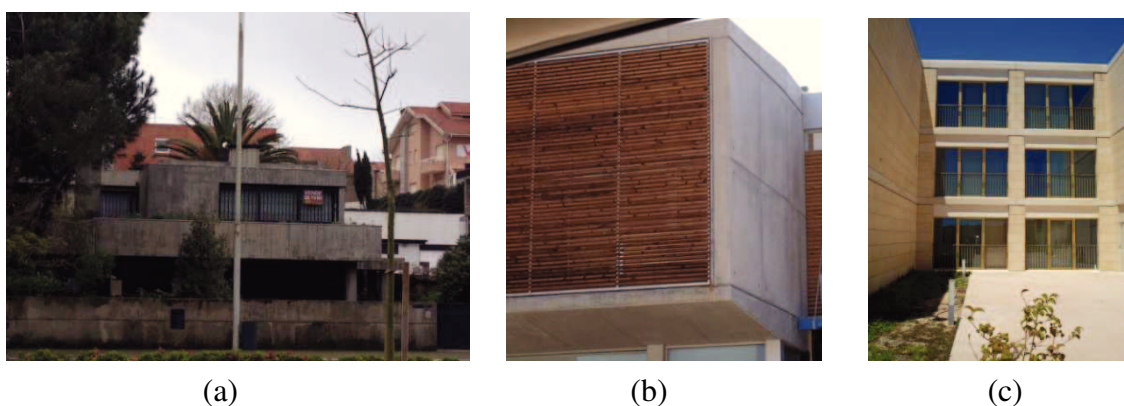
Betão aparente (a) edifício no Porto; (b) edifício em Vilamoura; Painéis de betão prefabricado (c) edifício em Vilamoura
